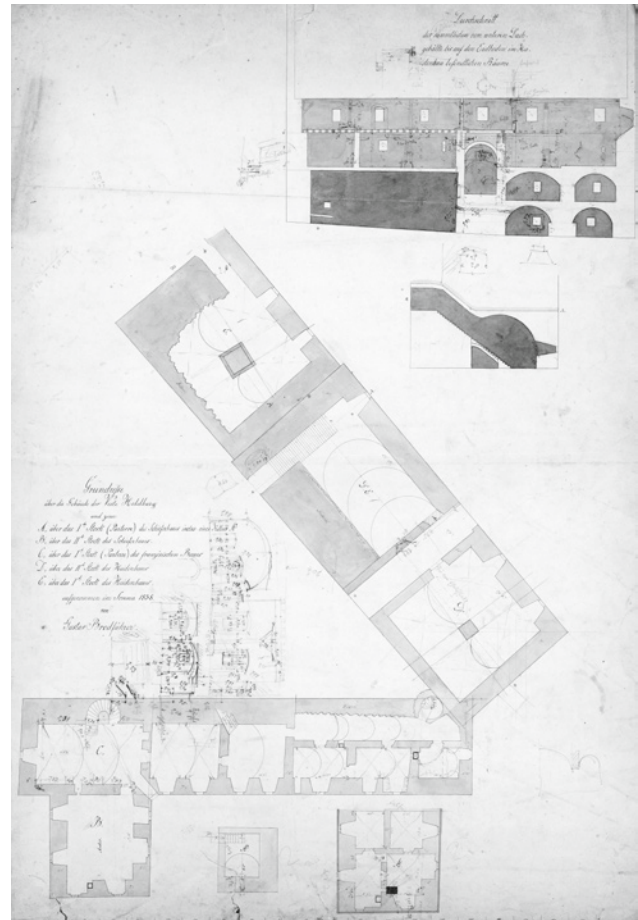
Bestandsplan des Heidenbaus mit Grundriss und Längsschnitt, aufgenommen von Gustav Brodführer 1838, ThStA Meiningen, Hofbauamt Mappe 11 Blatt I
